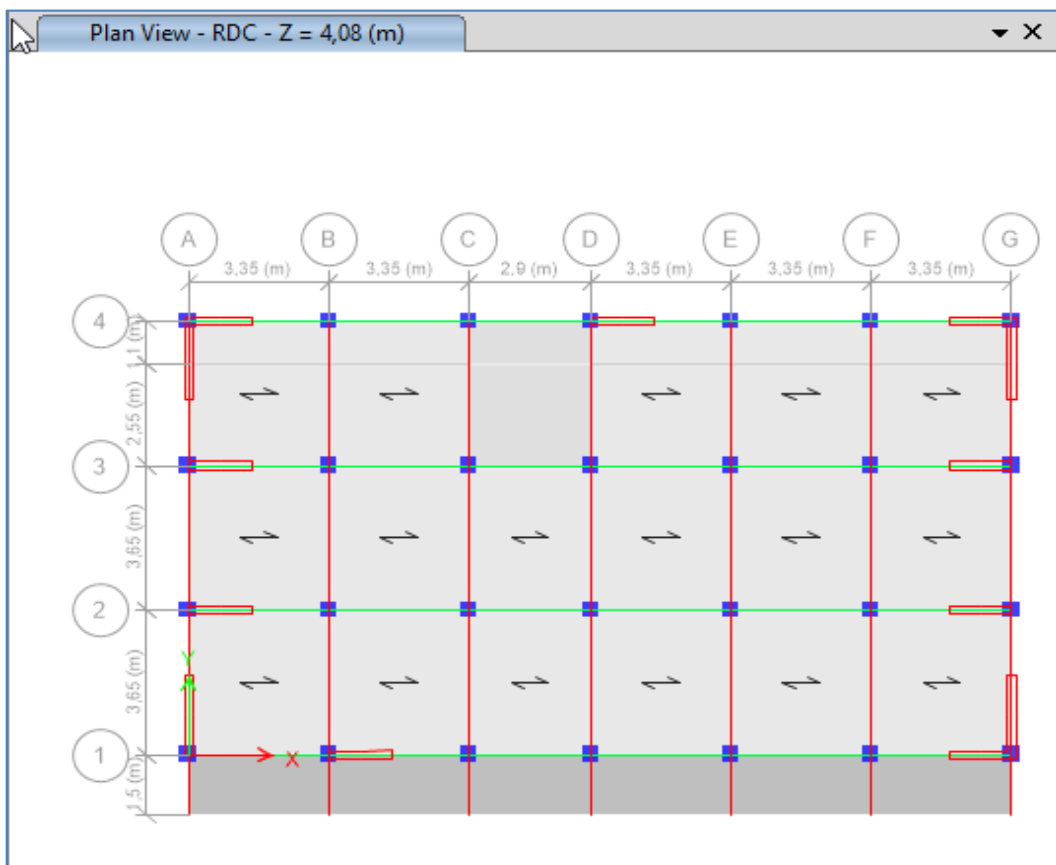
Vue en plan des éléments structuraux d'un étage
